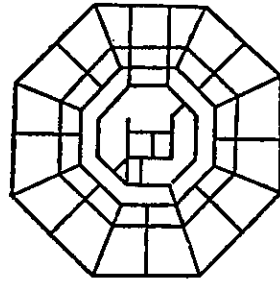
Công ty Thuốc lá tỉnh Phúc Kiến (21 tầng, 68m)
